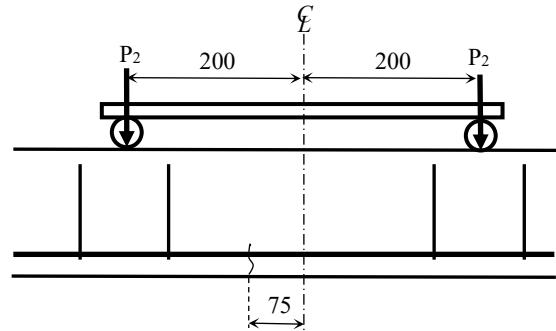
載荷板と試験体 1 のひび割れの位置
